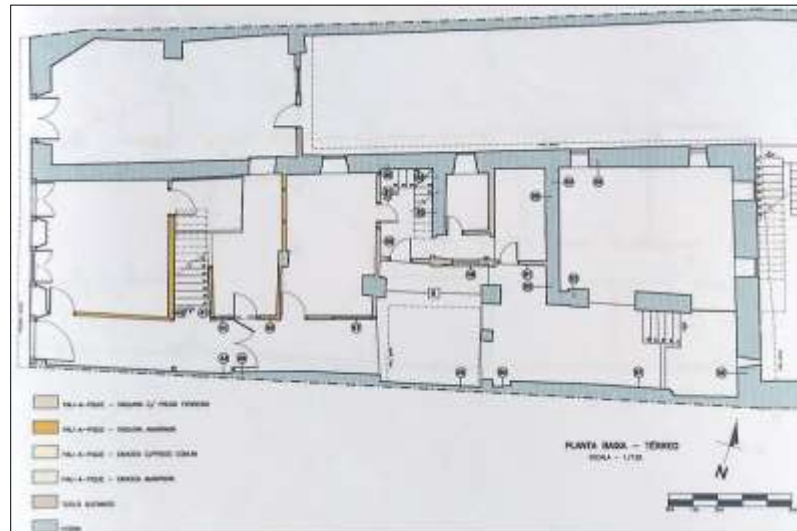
Planta baixa do pavimento térreo da Casa da Baronesa, com identificação dos materiais.
